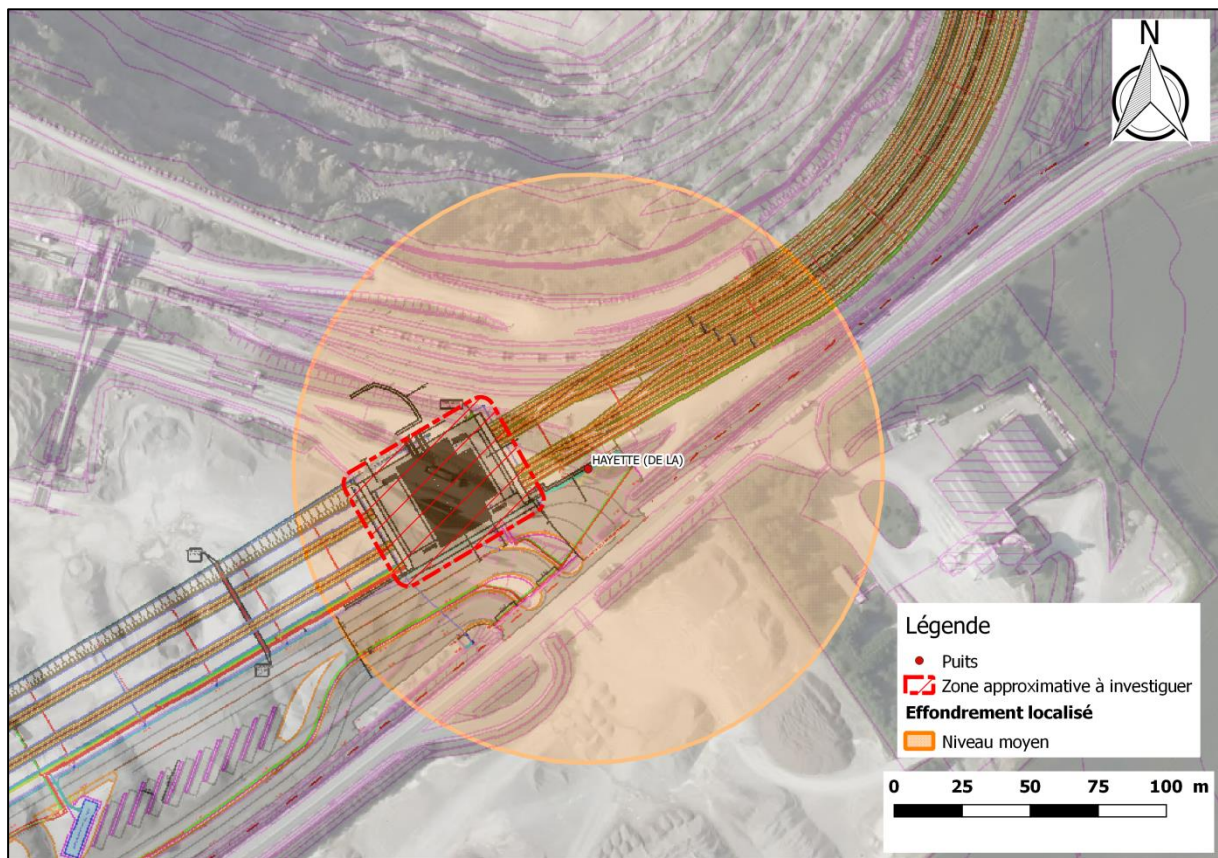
Plan du projet de construction (sur fond BD ORTHO® de l'IGN) et zone d'investigation proposée (en rouge) pour la recherche du puits FP14
